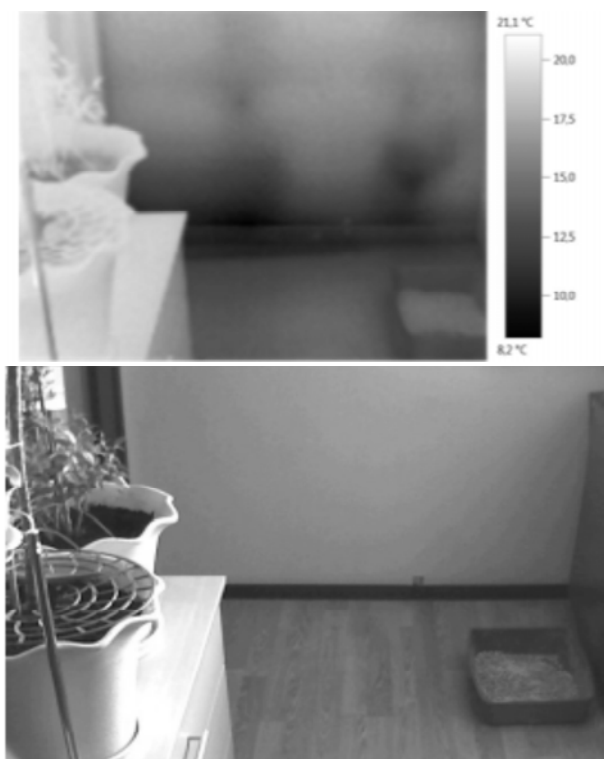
Результат тепловизионного обследования наружной стен жилого дома, построенного по технологии ЛСТК (внутренняя поверхность примыкания наружной стены к цокольному перекрытию)
